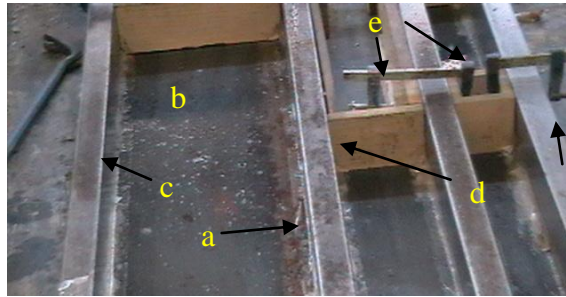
Fôrmas montadas sobre chapa de aço, juntamente com perfis metálico.
